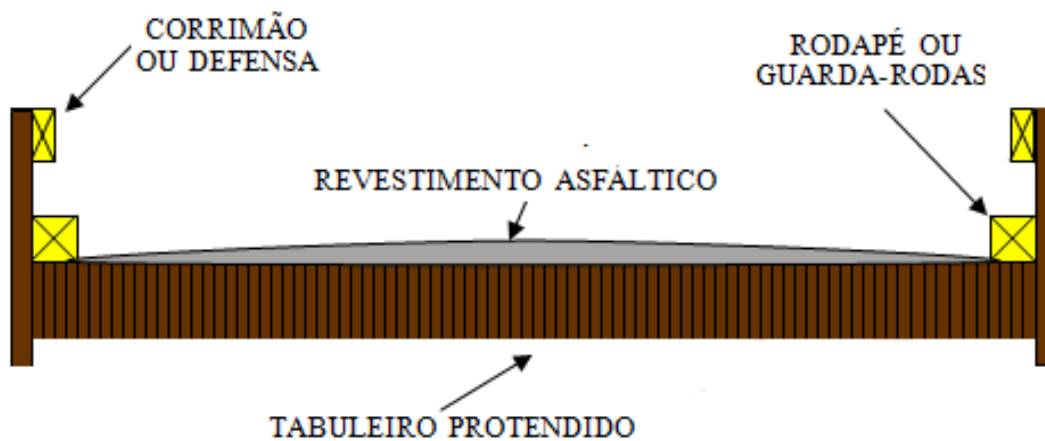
Corte transversal de ponte de madeira protendida com revestimento asfáltico
